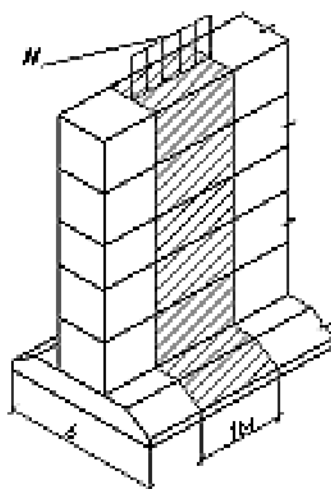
Схема збору навантажень на 1м довжини фундаменту
